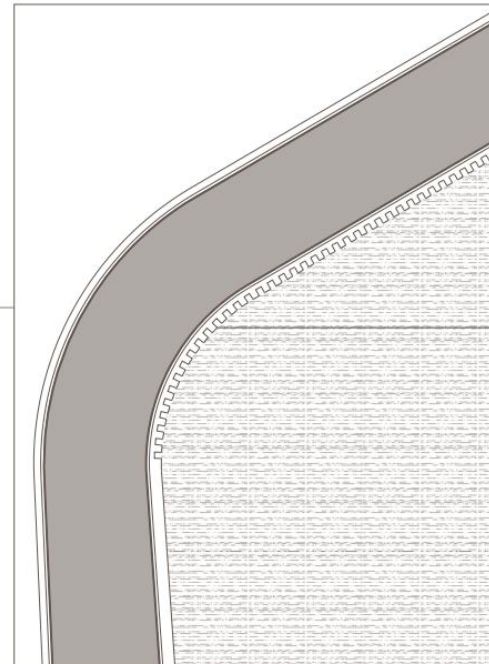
Detalles Constructivos Biblioteca Hunters Point (Autoría Propia 2025)
